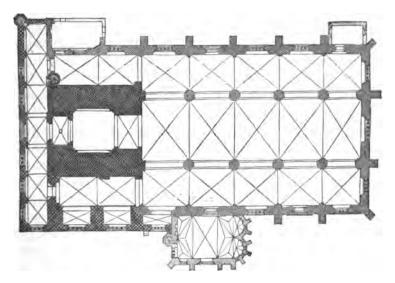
Greifswald. S. Marienkirche. Grundriss. 1:667.
